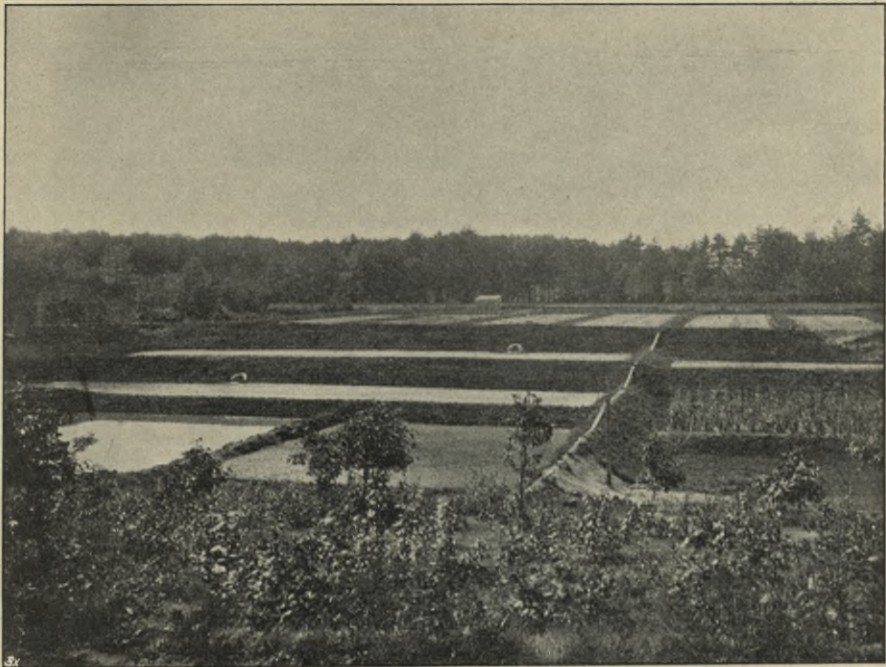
Abwasser-Reinigung durch intermittierende Bodenfiltration in Andover bei Boston.
